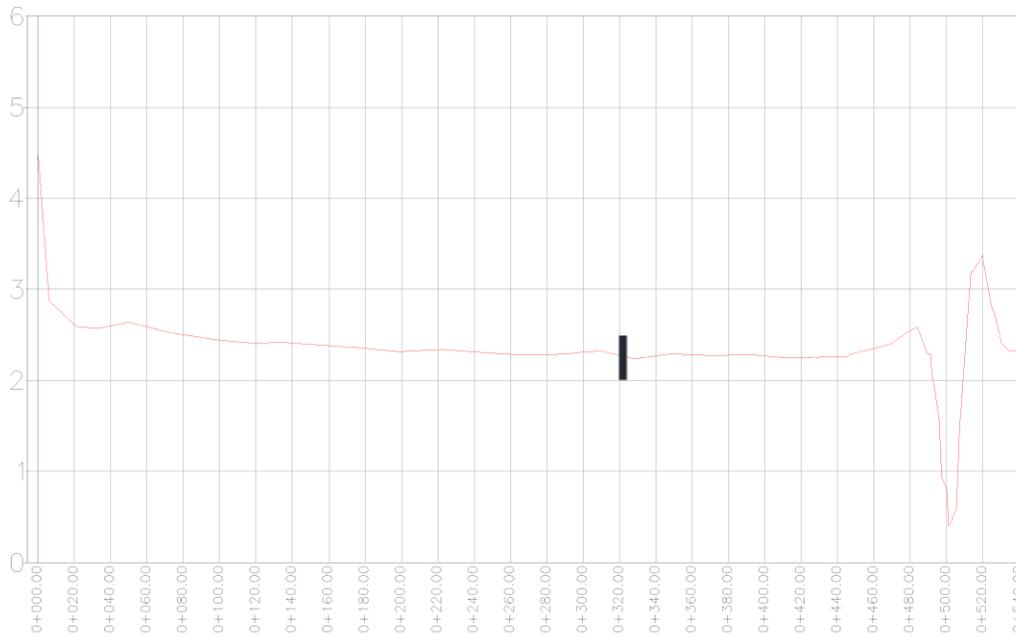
Sección de levantamiento topográfico de área de dren.
